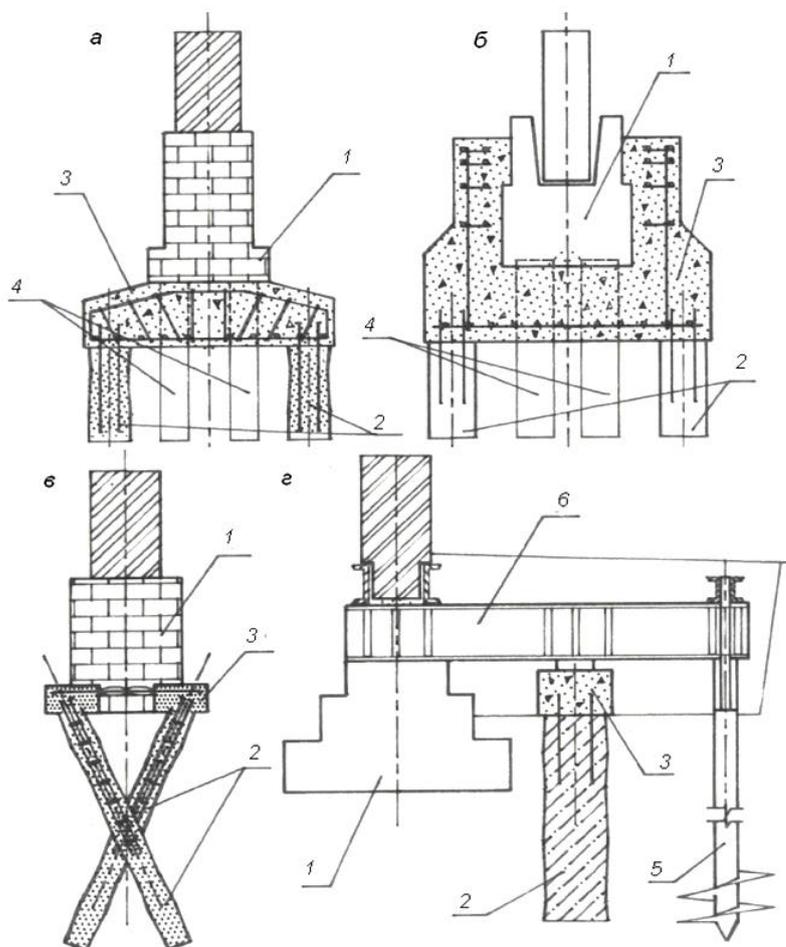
Усиление фундаментов сваями: а – с подводкой нового ростверка под ленточный фундамент; б – то же под столбчатый фундамент; в – наклонными сваями; г – сваями с одной стороны: 1 – существующий фундамент, 2 – сваи усиления, 3 – монолитный ростверк, 4 – существующие сваи, 5 – свая с винтовым наконечником, стальная балка
